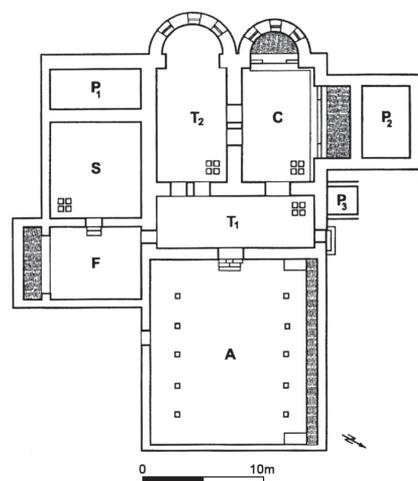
Grundrissplan Bauphase 2 mit repräsentativ gestaltetem Apodyterium.
